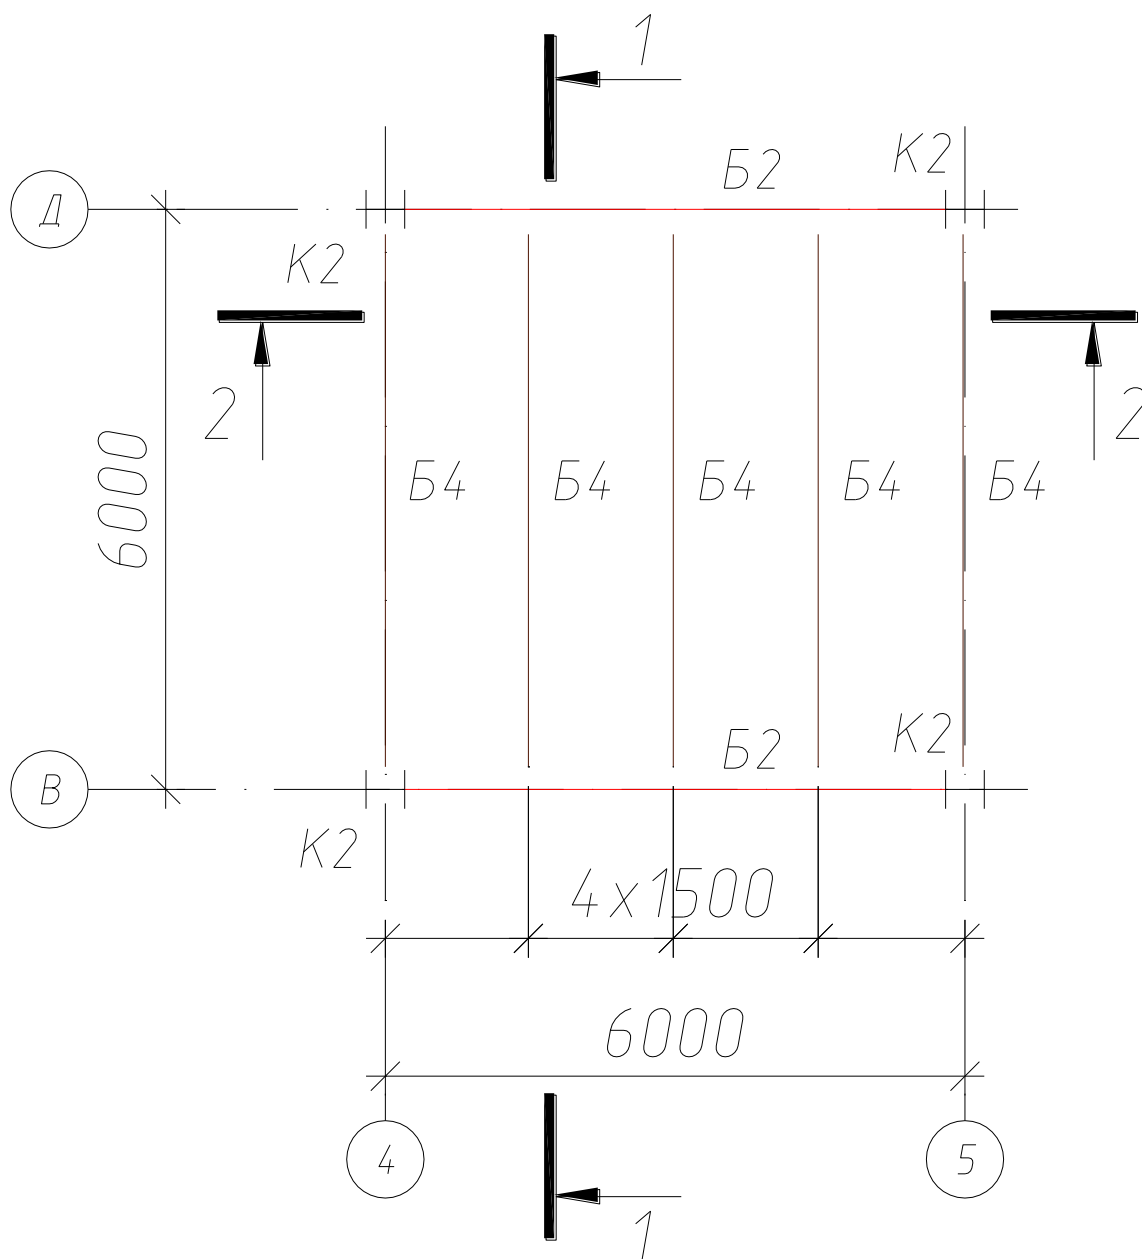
Компоновка ячейки балочной клетки перекрытия
